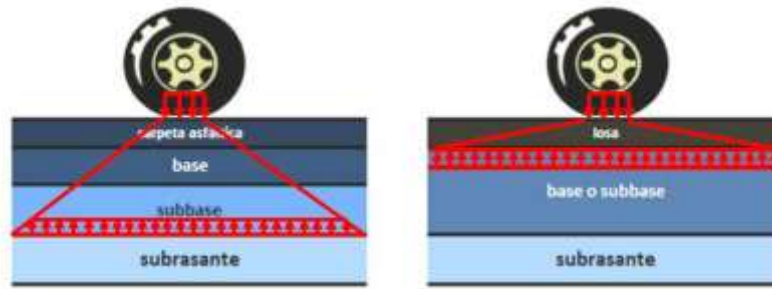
Comportamiento estructural de los pavimentos flexibles y rígidos
